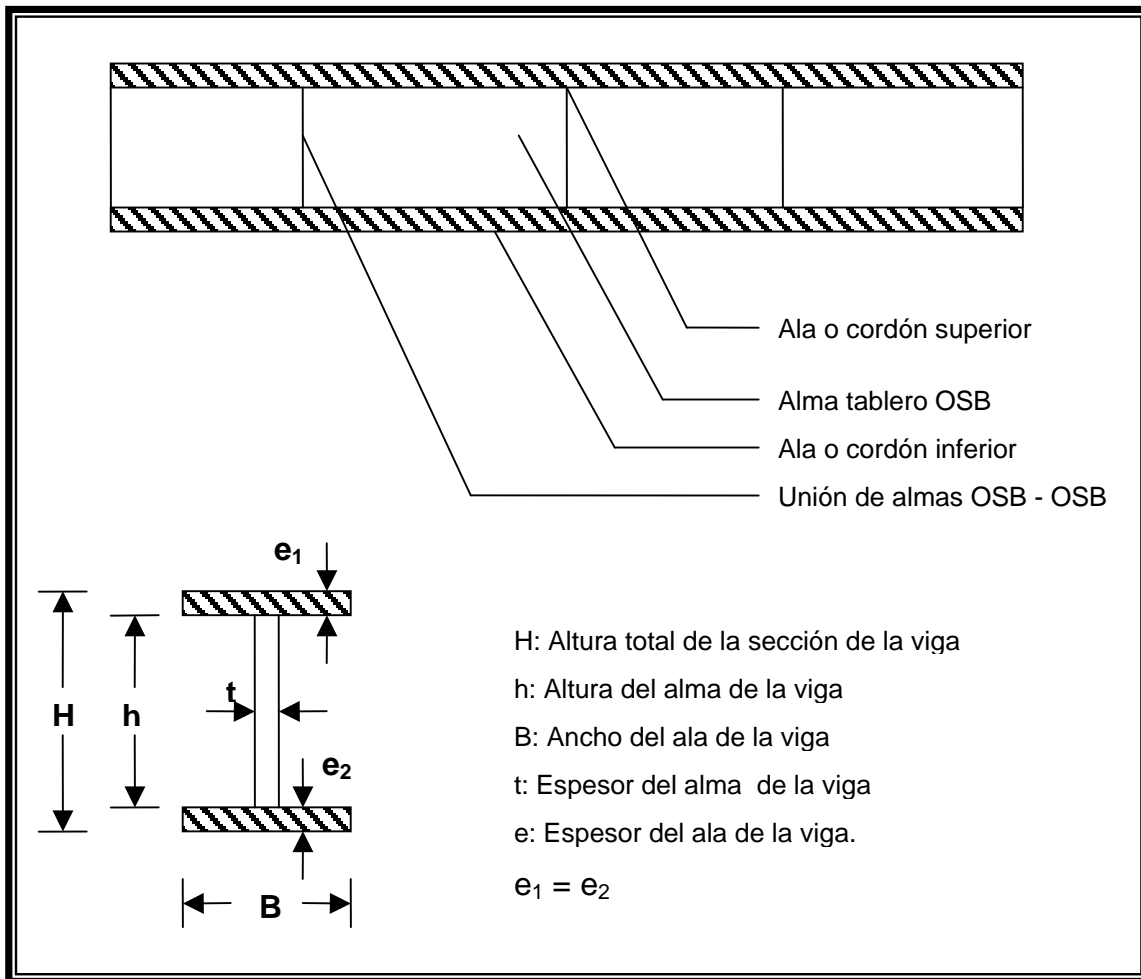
Sección transversal y longitudinal en vigas doble T con alma de OSB.
